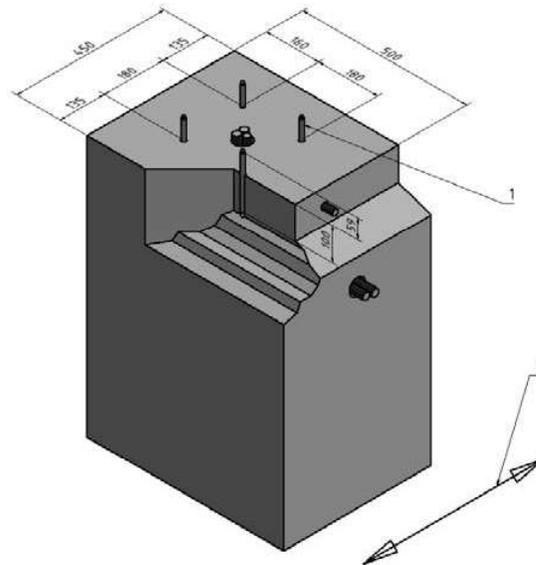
Plan de perçage pour les ancrés de fondation, dimensions en mm
